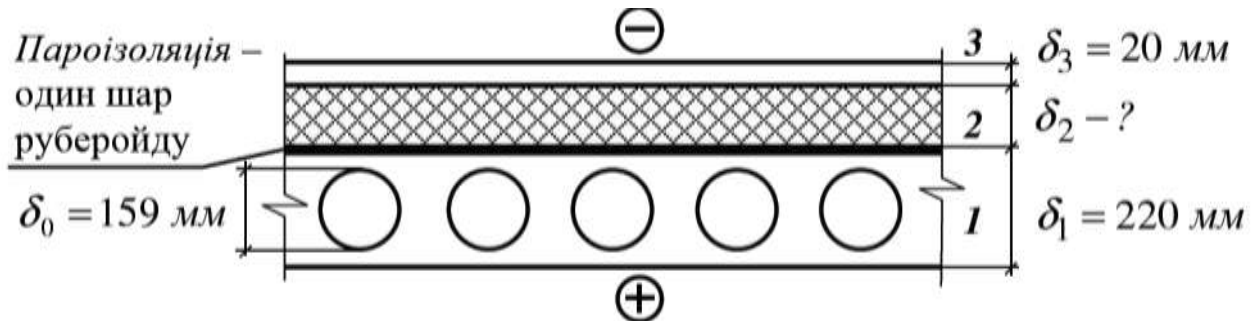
Розрахункова схема горищного перекриття житлової будівлі
